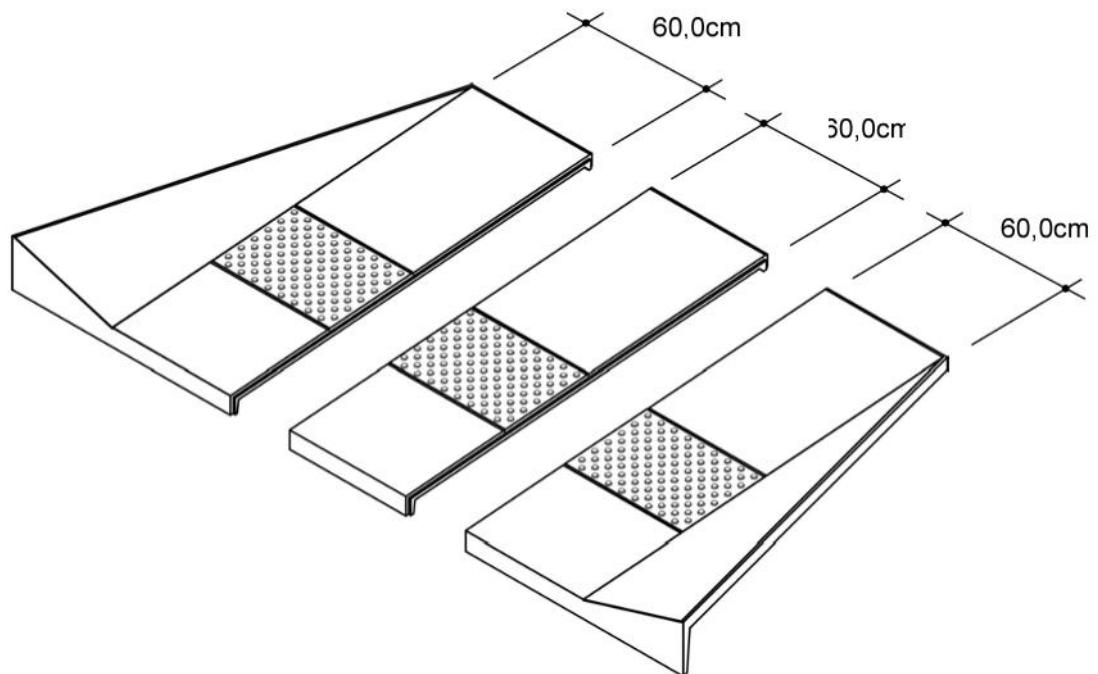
Dimensões genéricas do rebaixamento de calçada Tipo I-A
